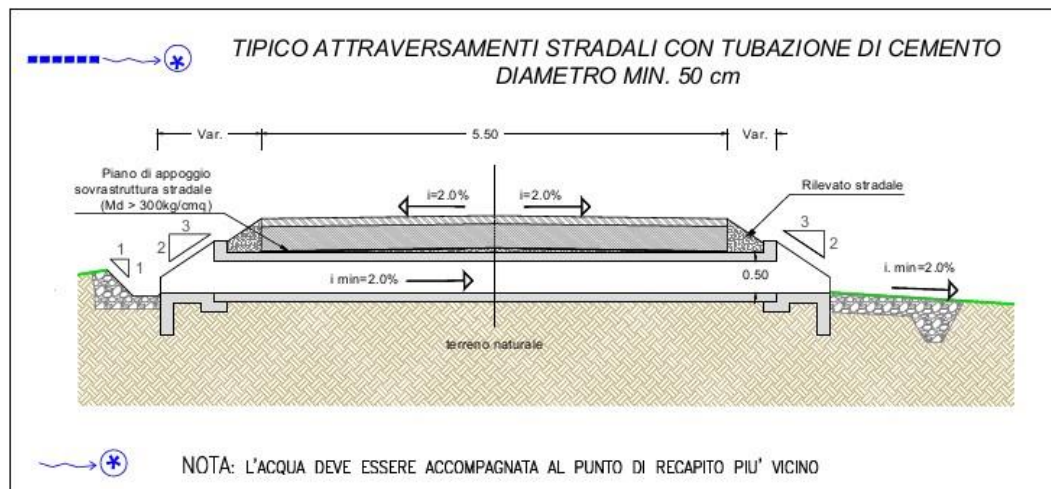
Sezione tipica di sezione stradale con condotta di attraversamento estratta dal progetto
